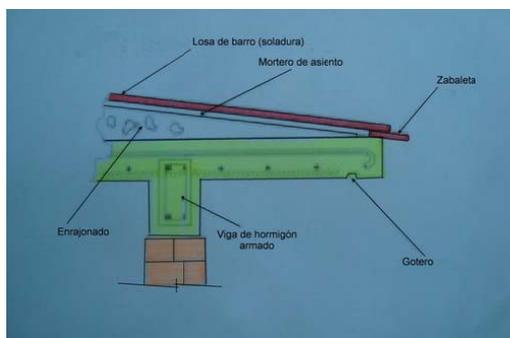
Detalle de enrajonado y soladura. Cubierta plana, Fuente: http://www.ecured.cu/index.php/Cubierta_de_hormigón_armado.
